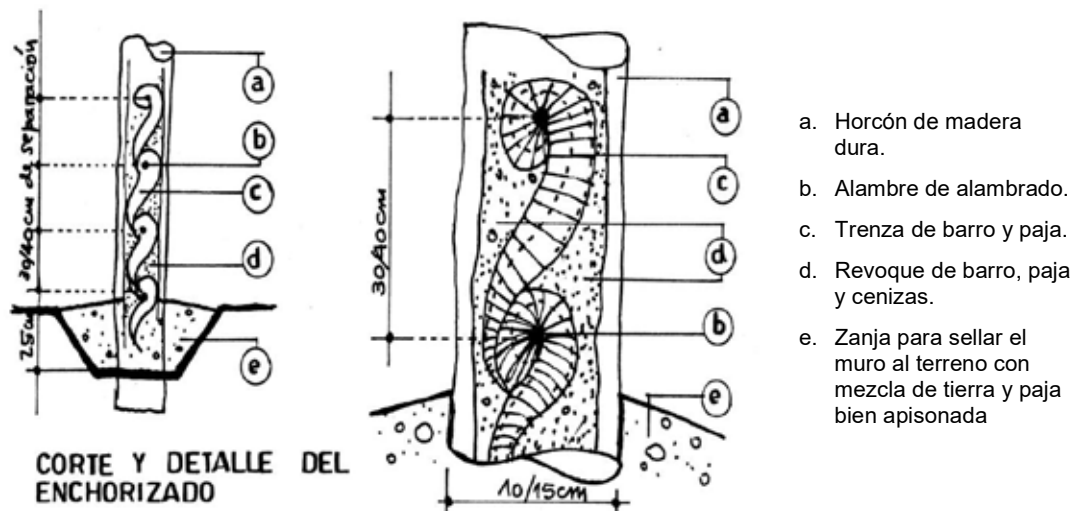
Muro con Enchorizado (Salas 1990: 42)
